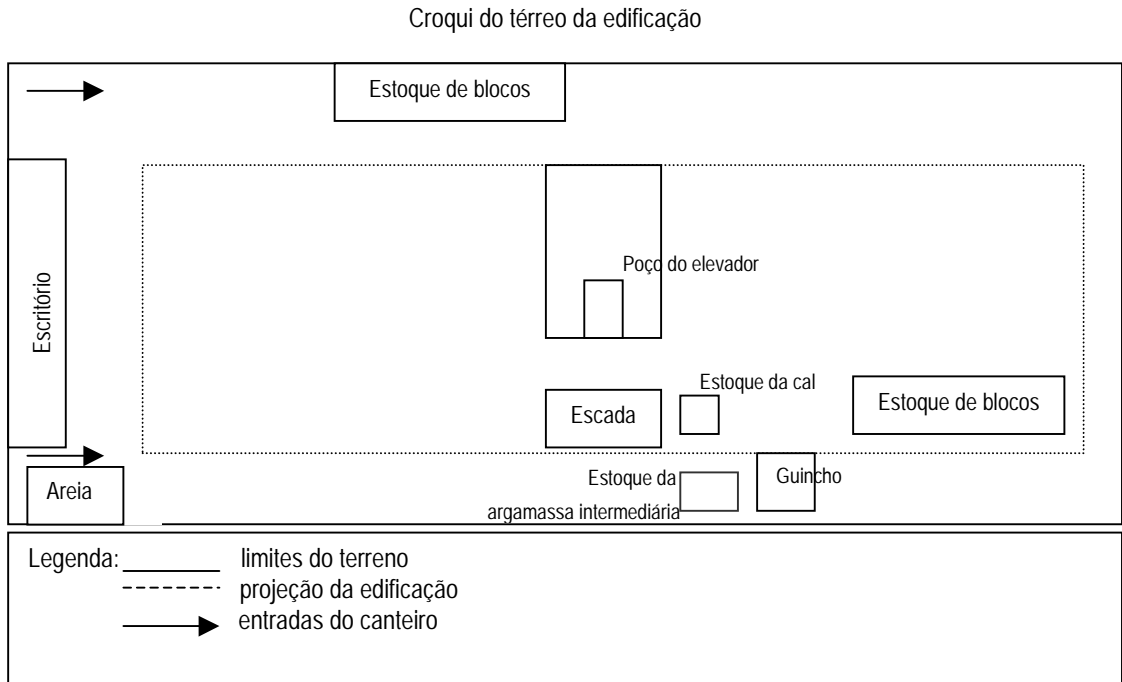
Desenho esquemático do térreo da edificação da Empresa A
